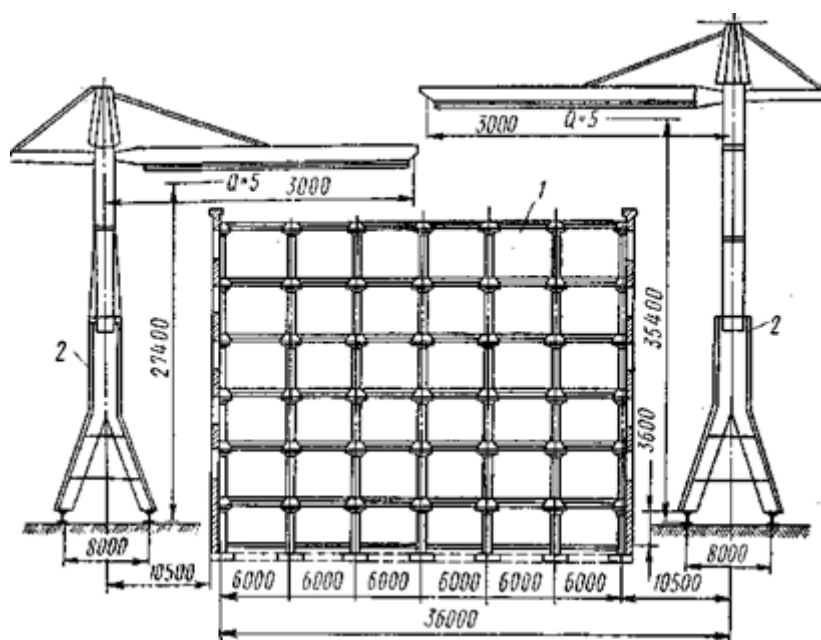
Схема монтажа многоэтажного промышленного здания: 1 — каркас; 2 — башенные краны
